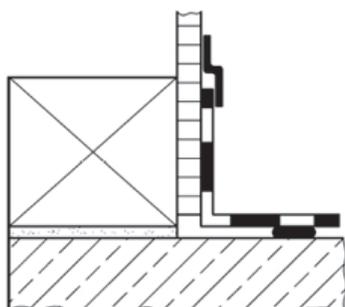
Anschluss der Luftdichtheitsschicht an eine Fundamentplatte aus Beton mit Klebemasse (DIN 4108-7, 2011, Bild 23)
